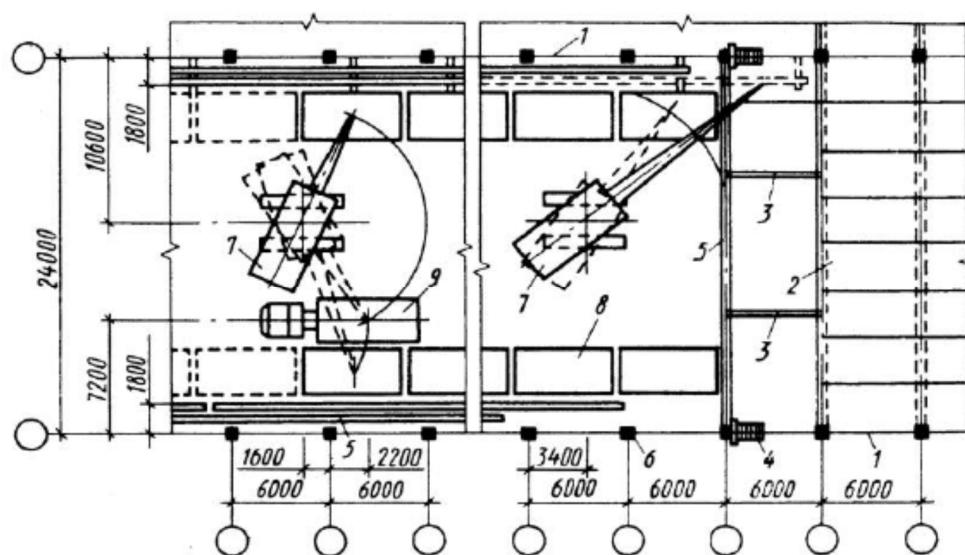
Схема выгрузки, раскладки элементов и монтажа покрытия в пролетах 24 м, с шагом колонн и ферм 6 м продольным методом: 1 - временное ограждение; 2 - смонтированное покрытие; 3 - инвентарная распорка для временного крепления ферм; 4 - лестница-площадка приставная; 5 - стропильная ферма; 6 - колонна; 7 - кран; 8 - штабель плит; 9 - транспортное средство.
